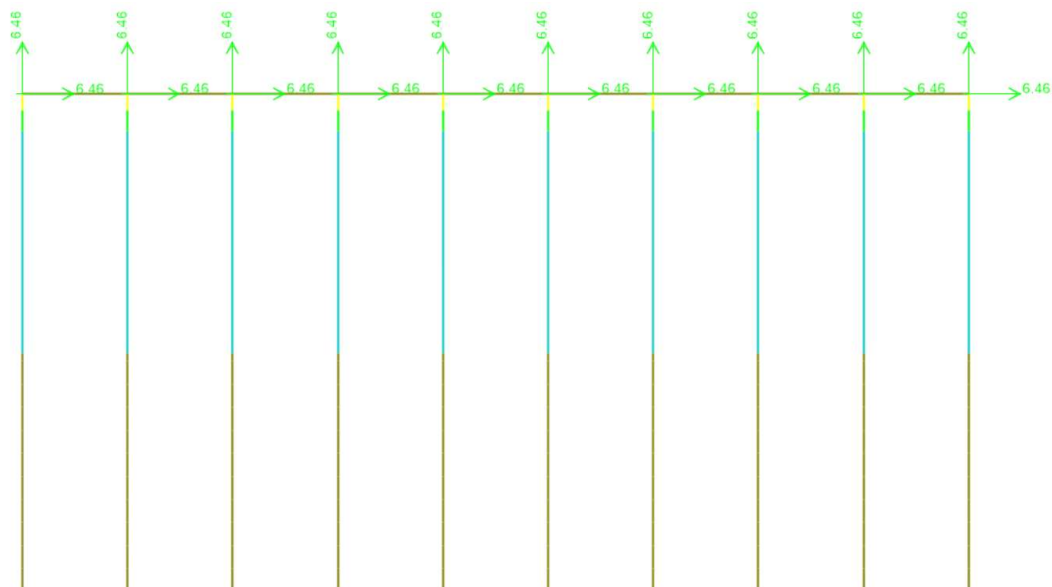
Joint Masses de pilotes verticales - Eje B (6.46 kN-s²/m)
